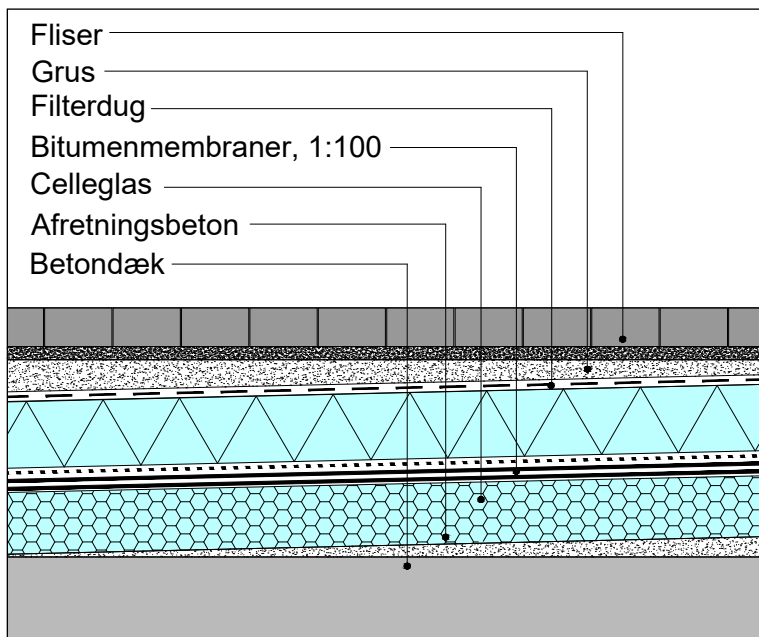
Isoleret P-dæk med kørebanebeton udført som omvendt tag.
